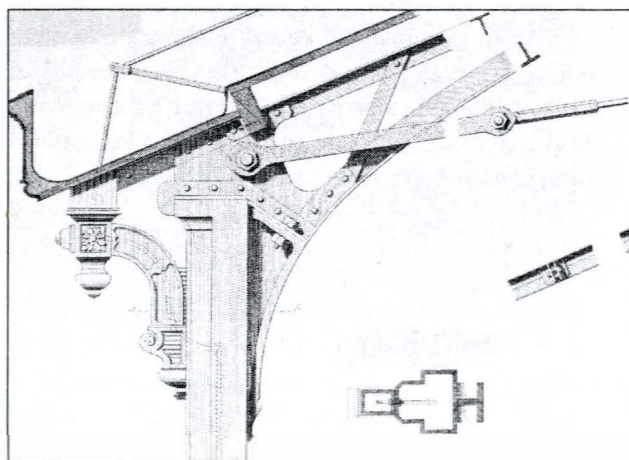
Estructura metálica del mercado de Santa Clara. París
